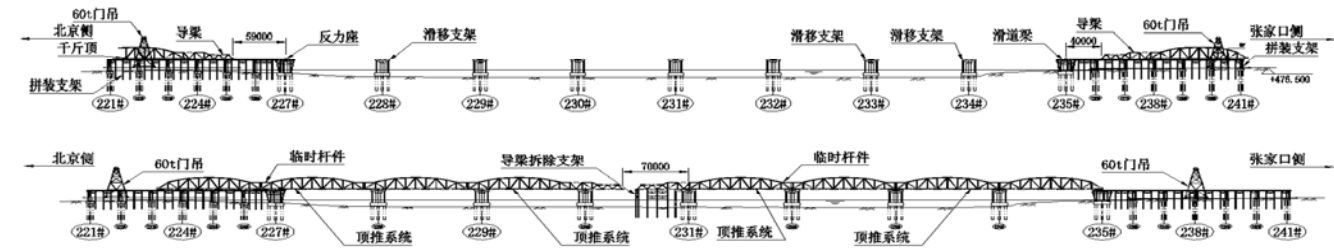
双侧顶推施工方案示意（立面）尺寸单位：mm 高程：m。
